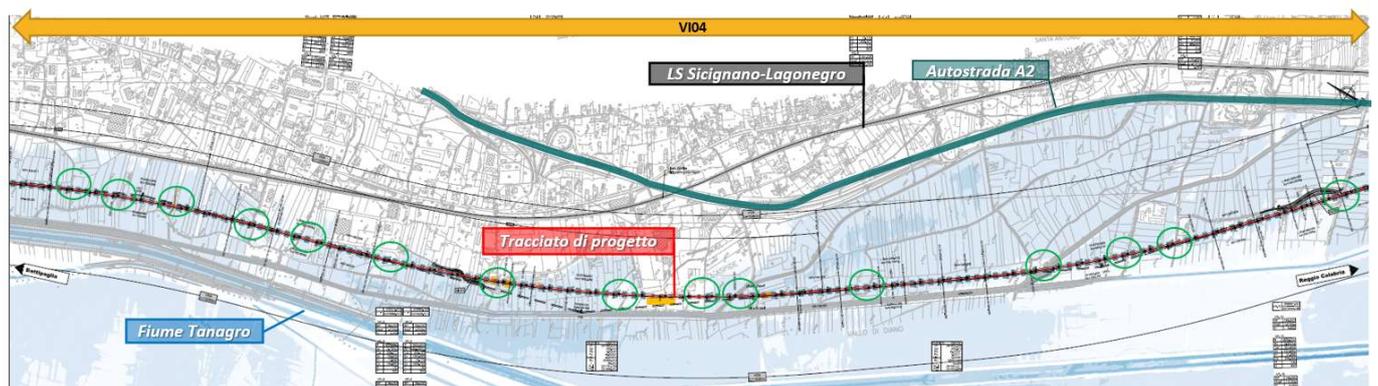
Planoprofilo di progetto da km 39+300 a km 41+486
